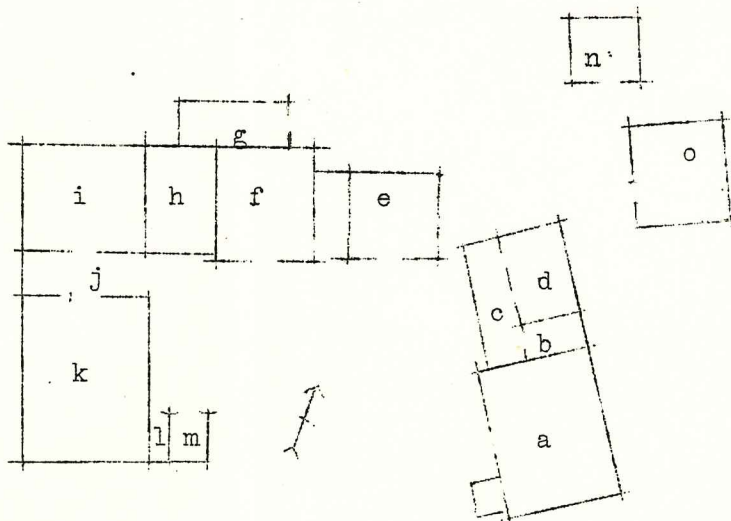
Plan. Skomåkärgården i Åsen. Älvd.Dal.
